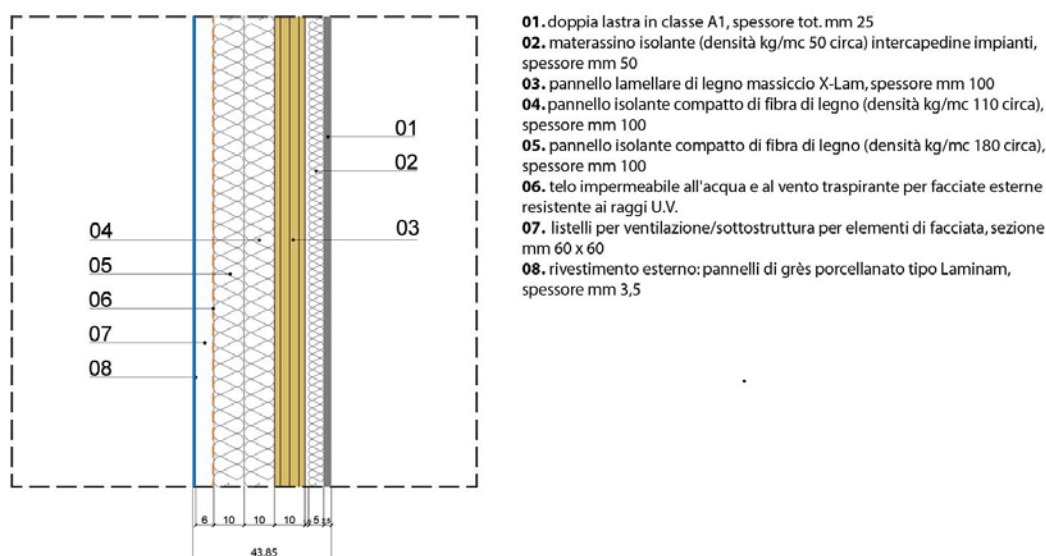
Sezione trasversale di parete tipo. La figura è allegata a scopo meramente illustrativo
